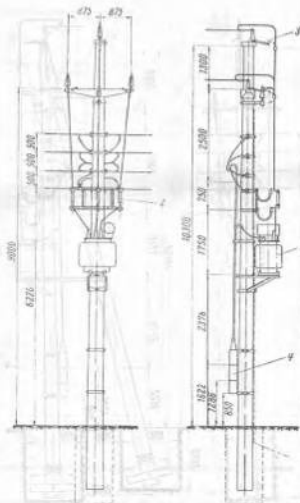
Post pe stâlpi de beton armat centrifugat, vibrați și precomprimat:
